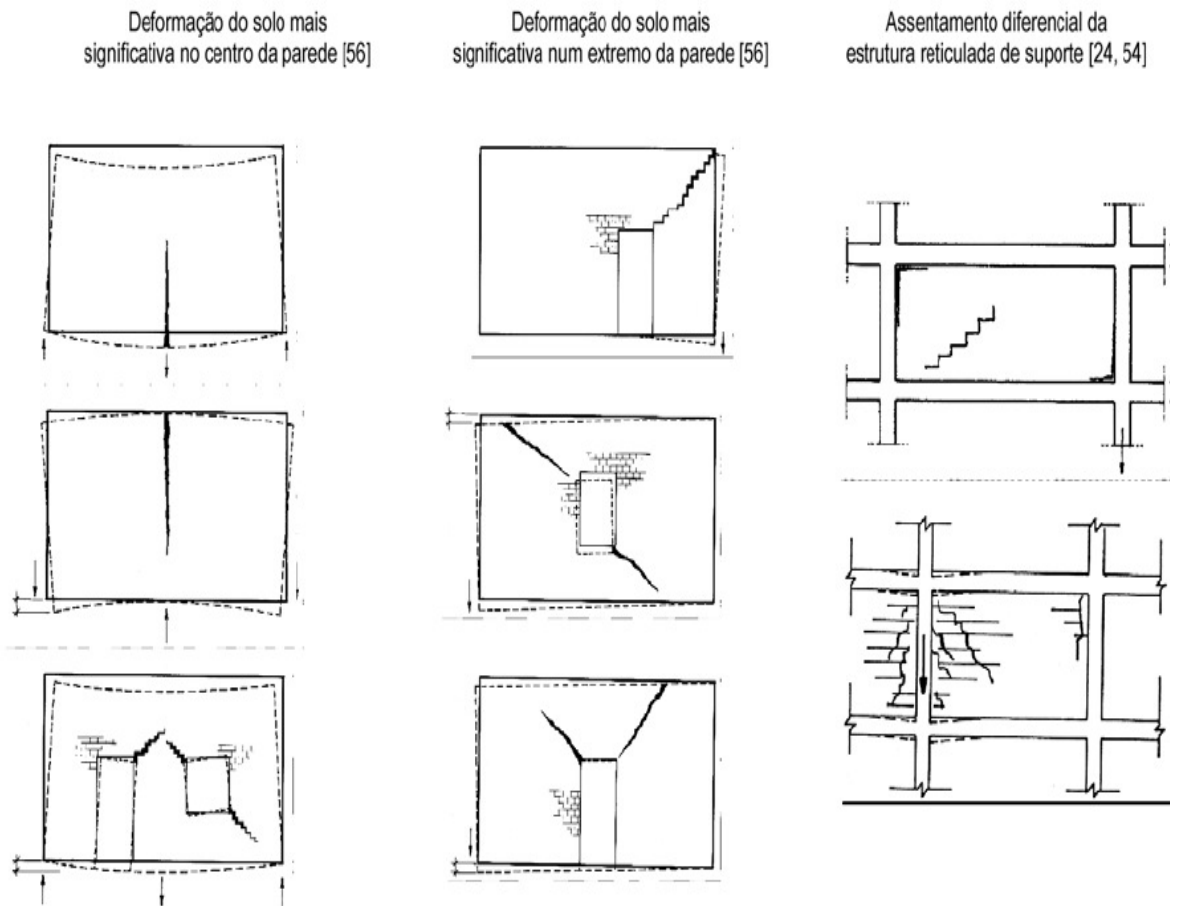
Exemplos de fissuração devida a movimentos da fundação - Padronizados
